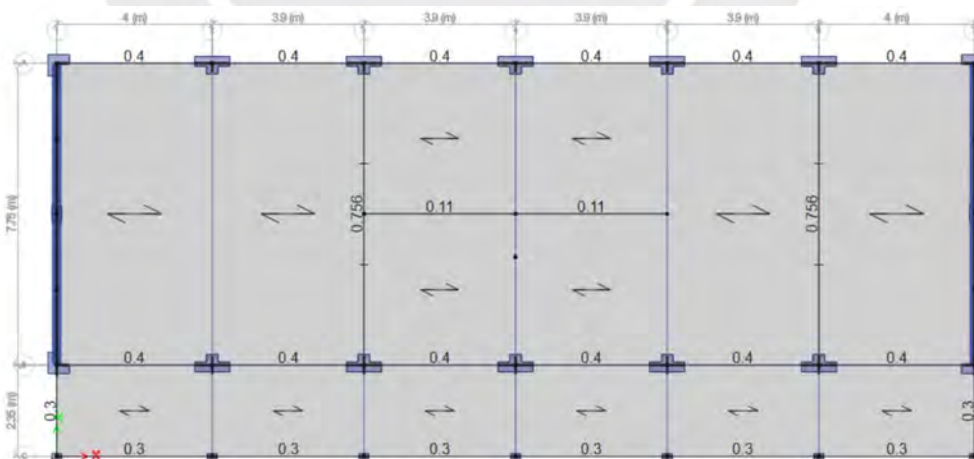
Carga distribuida en las vigas debido a la tabiquería (Techo 2/ETABS)
